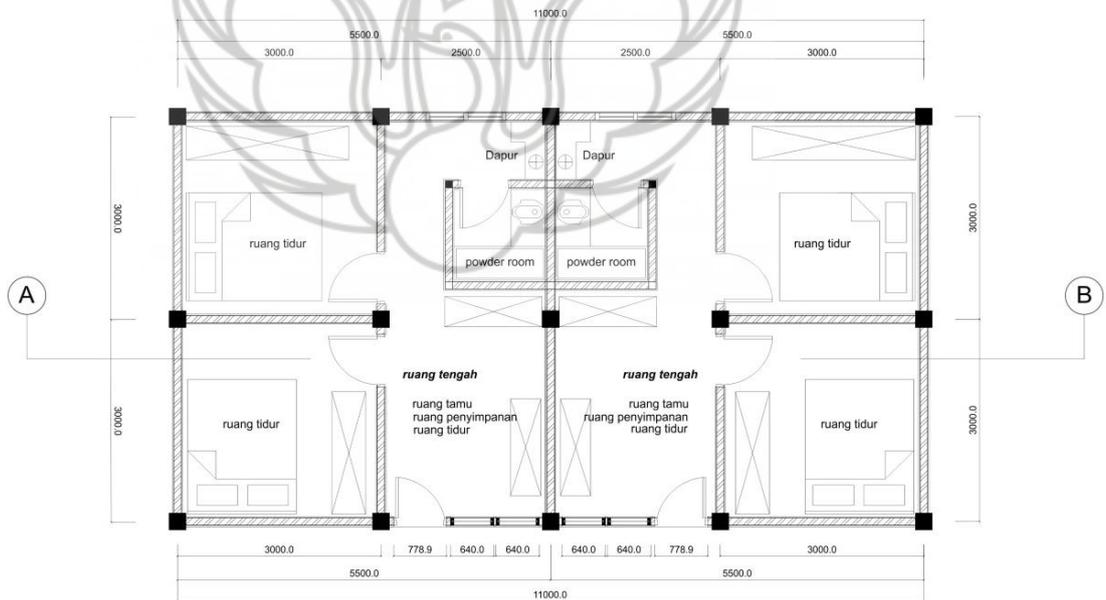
Denah Lantai dasar, dua, tiga dan empat Blok H
